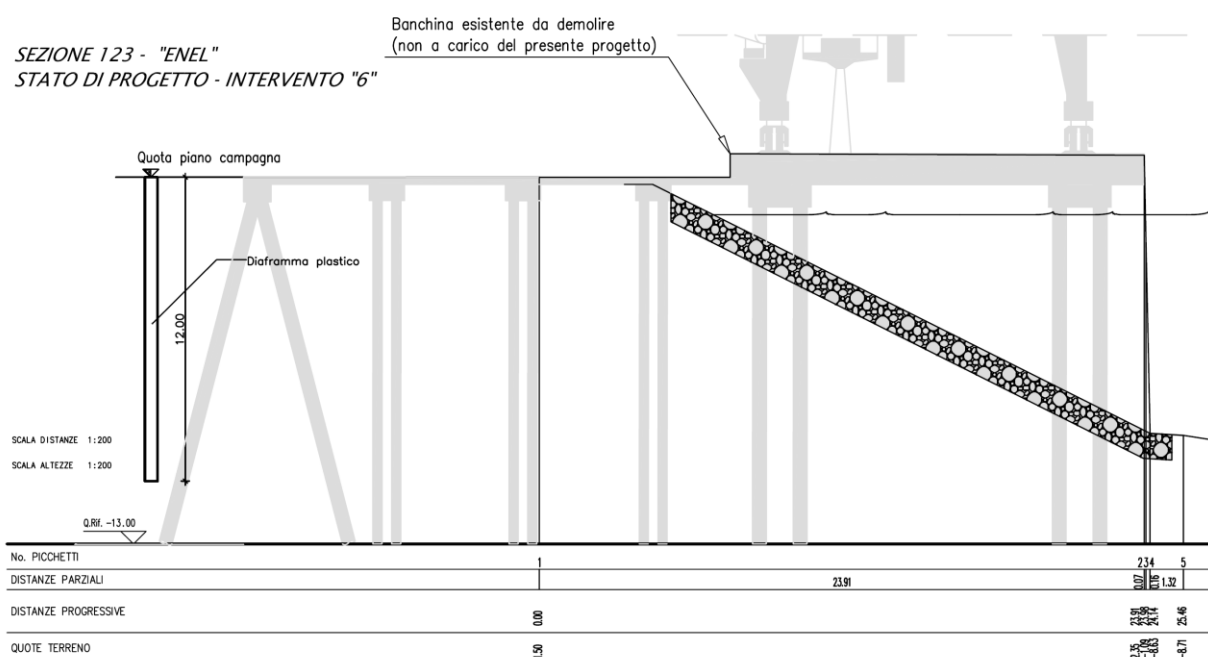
Progetto definitivo-Sezione dell'intervento con diaframma posto a 16 m dal filo canale
